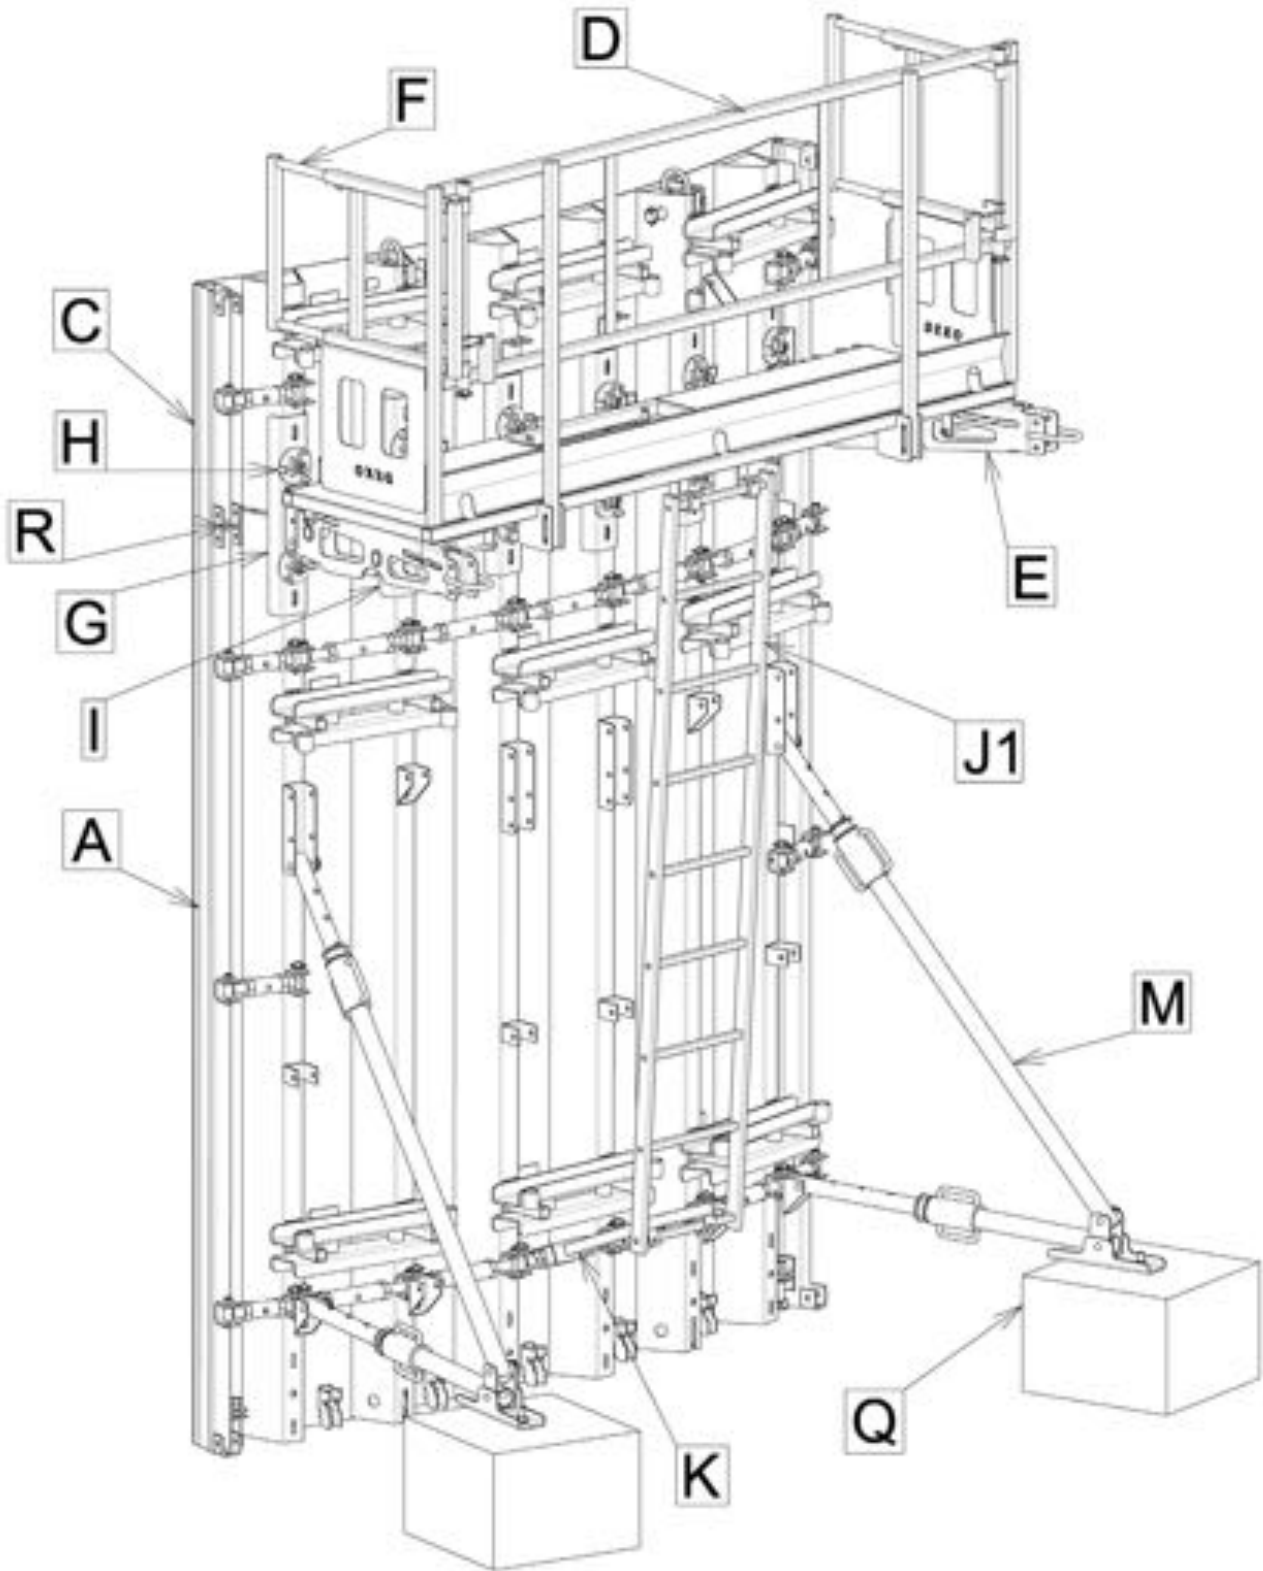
Assemblage d'une banche de 280 avec une réhausse de 70
